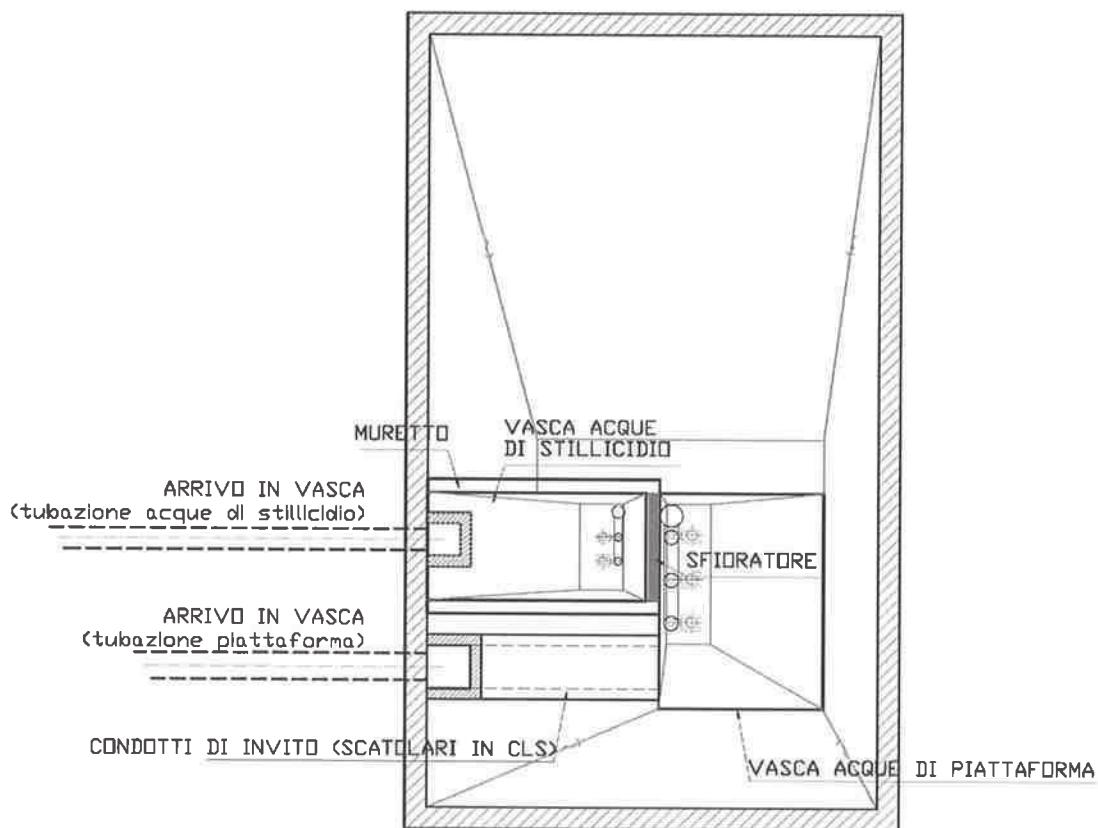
Stazione di sollevamento - Schema planimetrico della disposizione delle vasche di carico.
